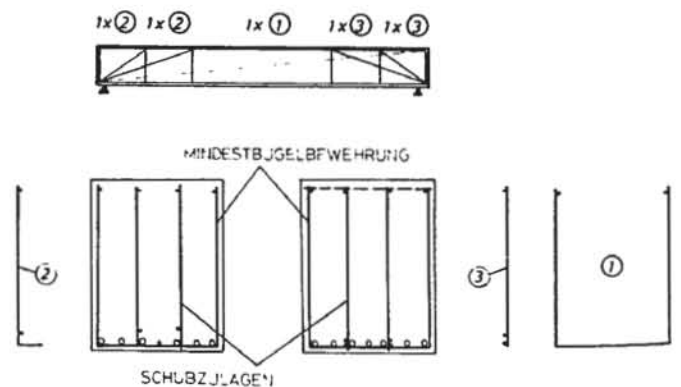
Querschnitt mit der Zugbewehrung umschließender Mindestbügelbewehrung und Schubzulagen
